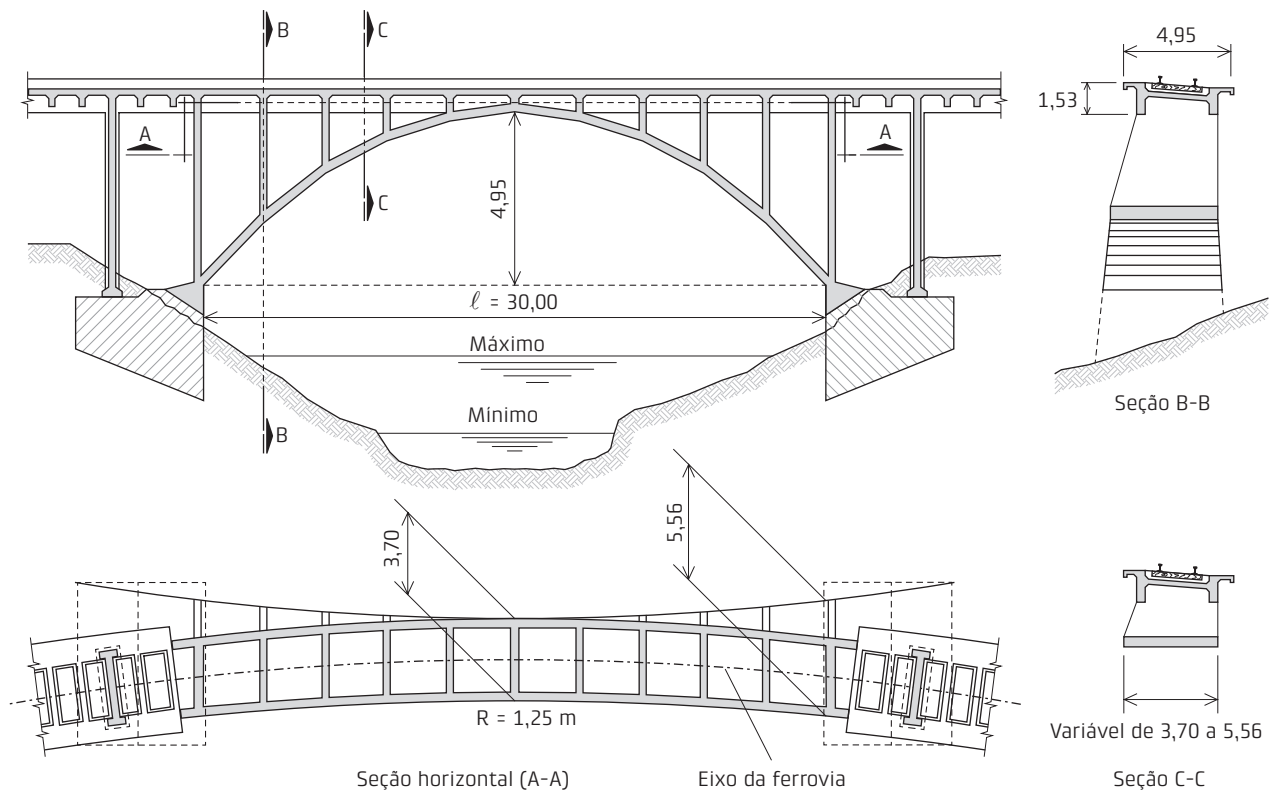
Ponte com estrutura principal com traçado reto implantada em trecho curvo da ferrovia (adaptado de Martinelli, 1978)
